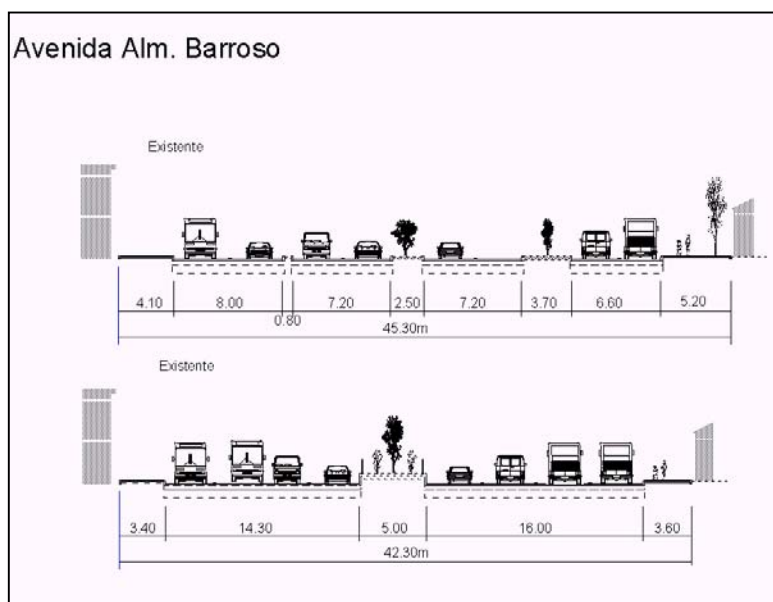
Seções Transversais-tipo da Avenida Almirante Barroso
